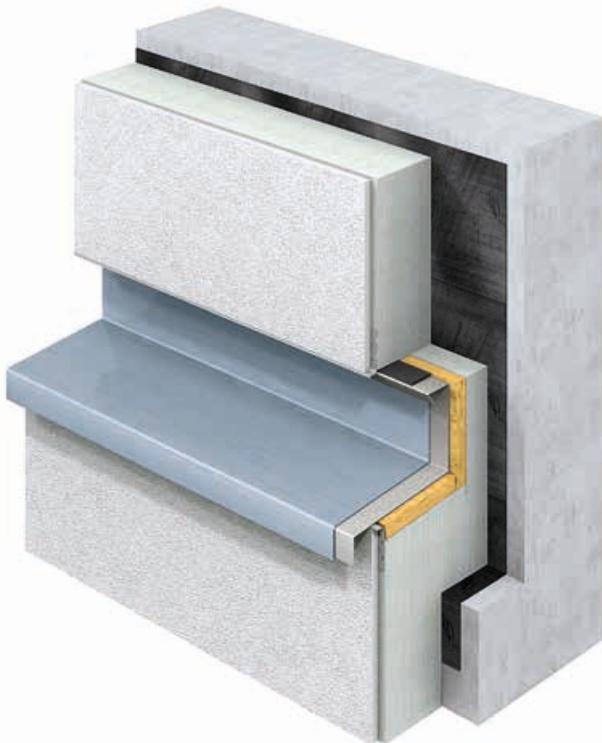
Construcción de cornisa con aislamiento exterior y sistema de acabado.
